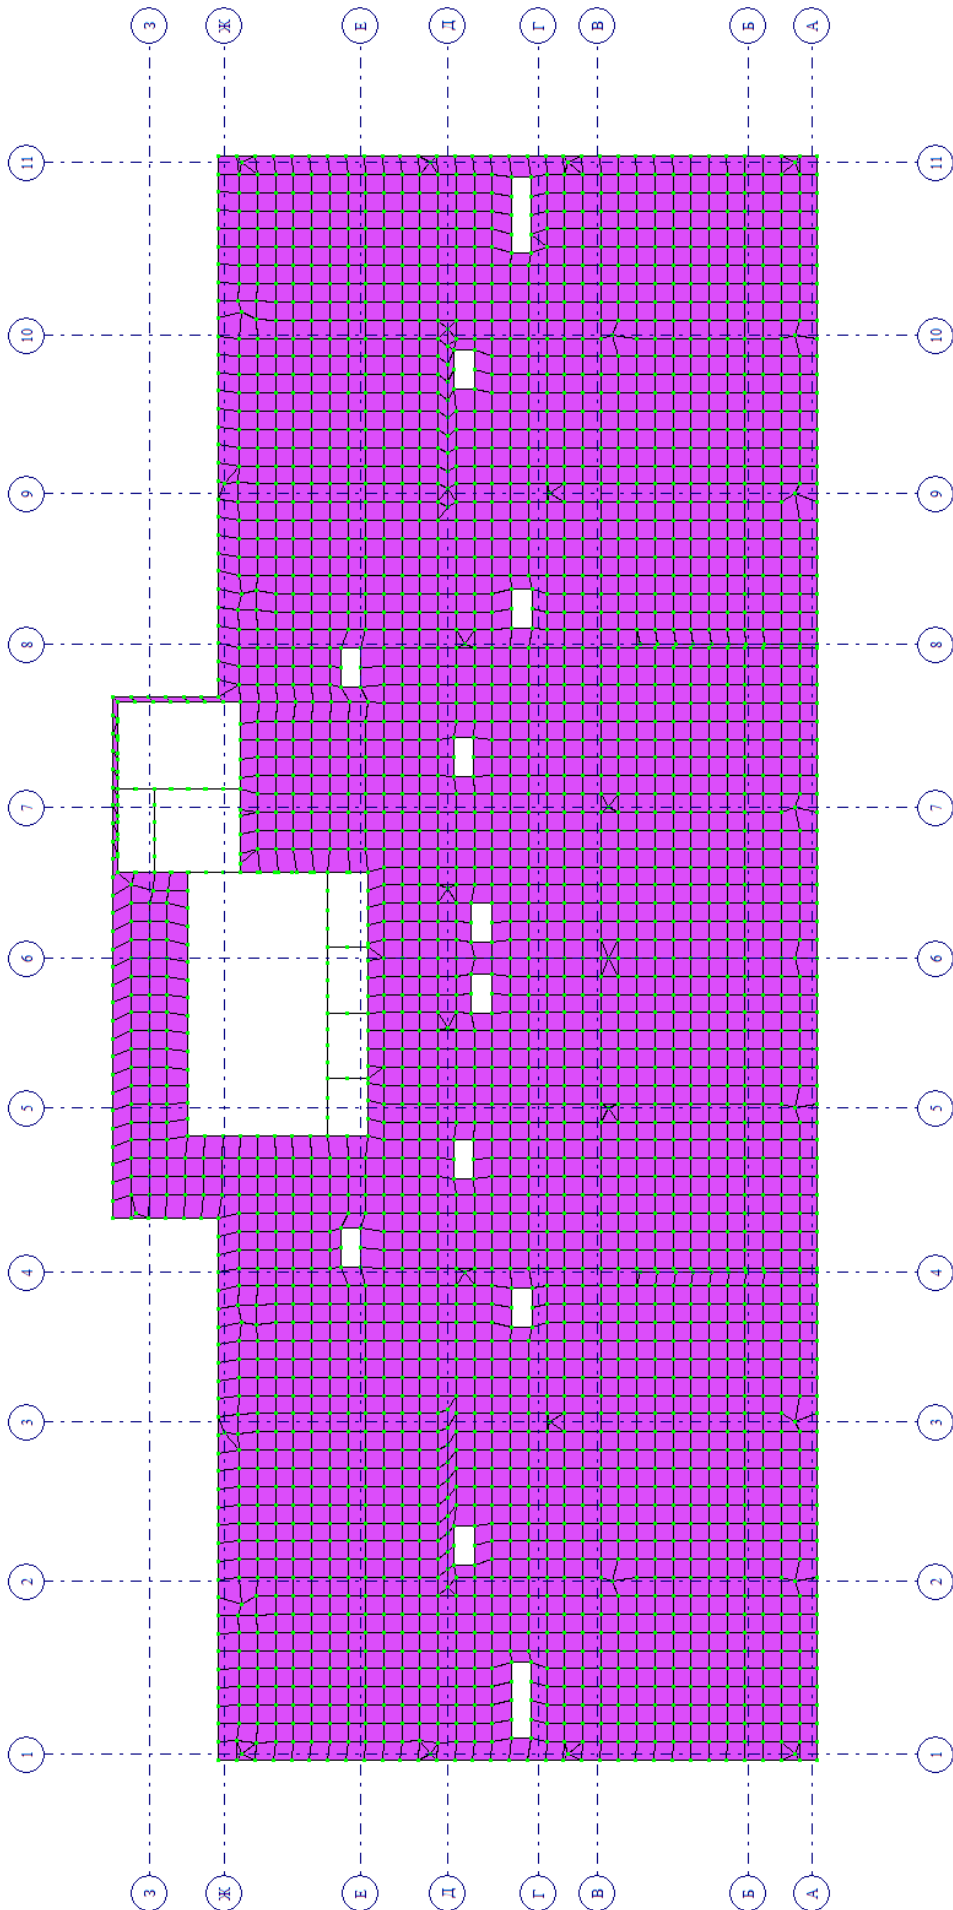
Зображення розрахункової схеми міжповерхового перекриття
